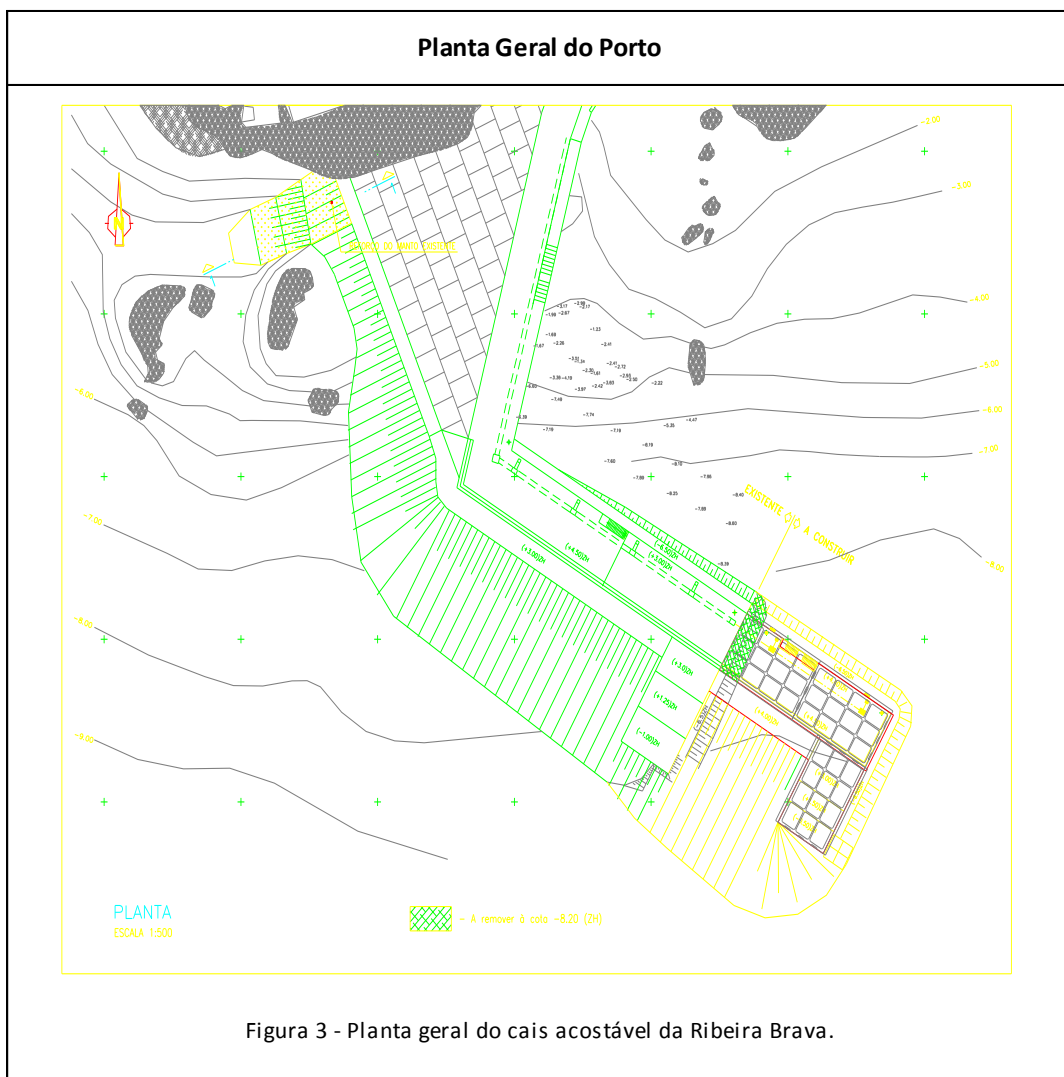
Planta geral do cais acostável da Ribeira Brava.
